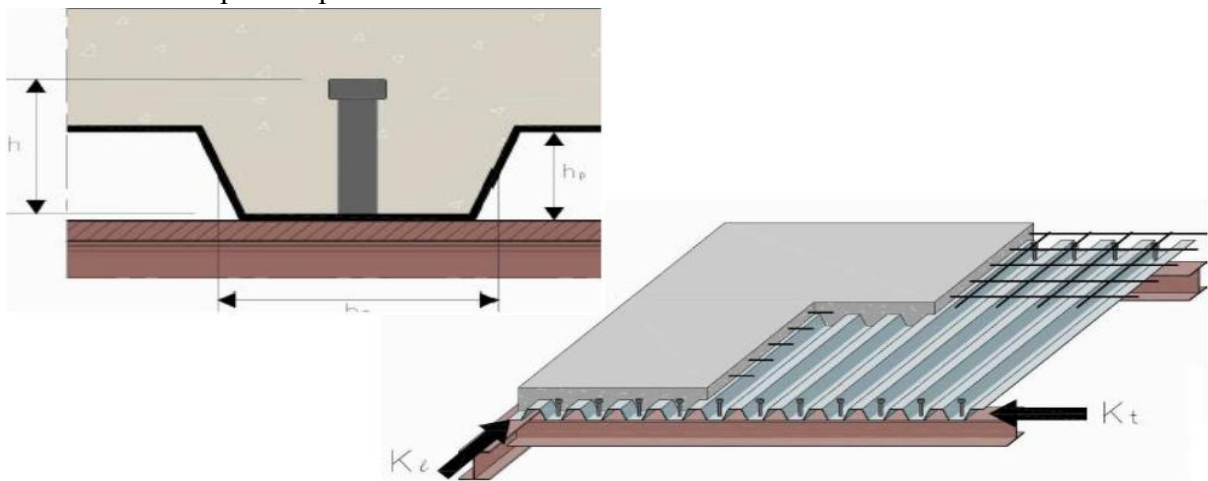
Goujons à tête soudés en présence d'une dalle mixte à bac collaborant
